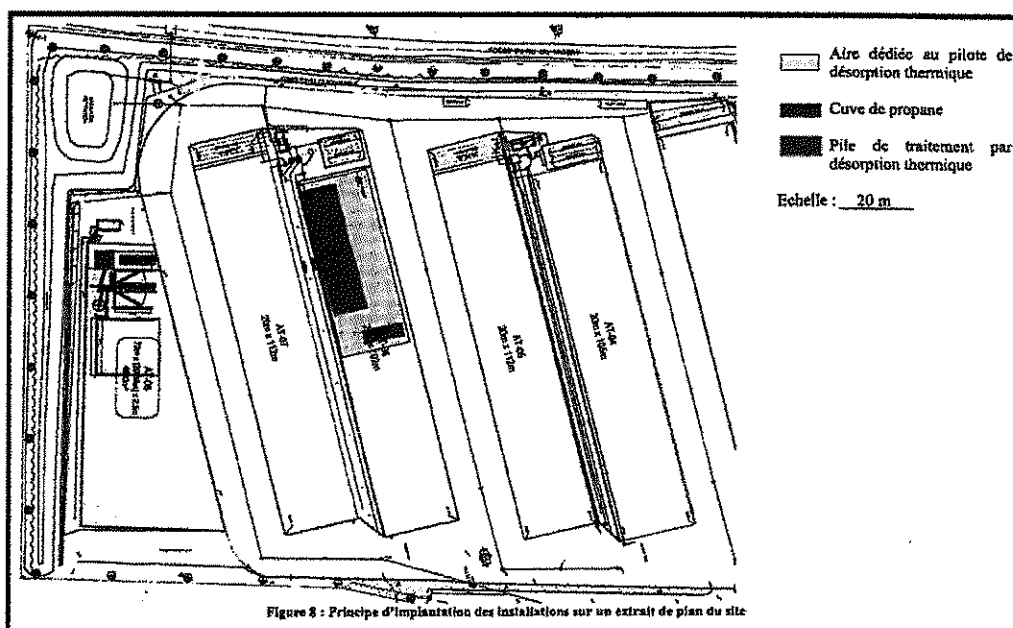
Principe d'implantation des installations sur un extrait de plan du site
